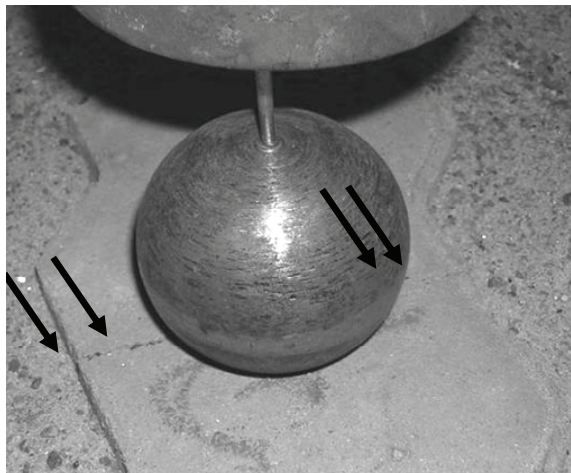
Última fissura observada (2 mm) em bloco intertravado de referência.
